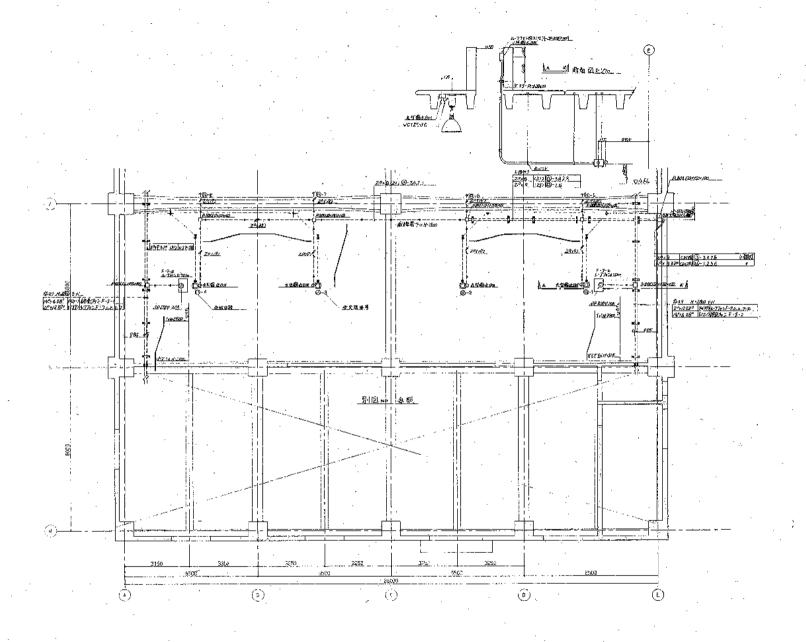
汚泥濃縮棟3 階平面図 図番10
